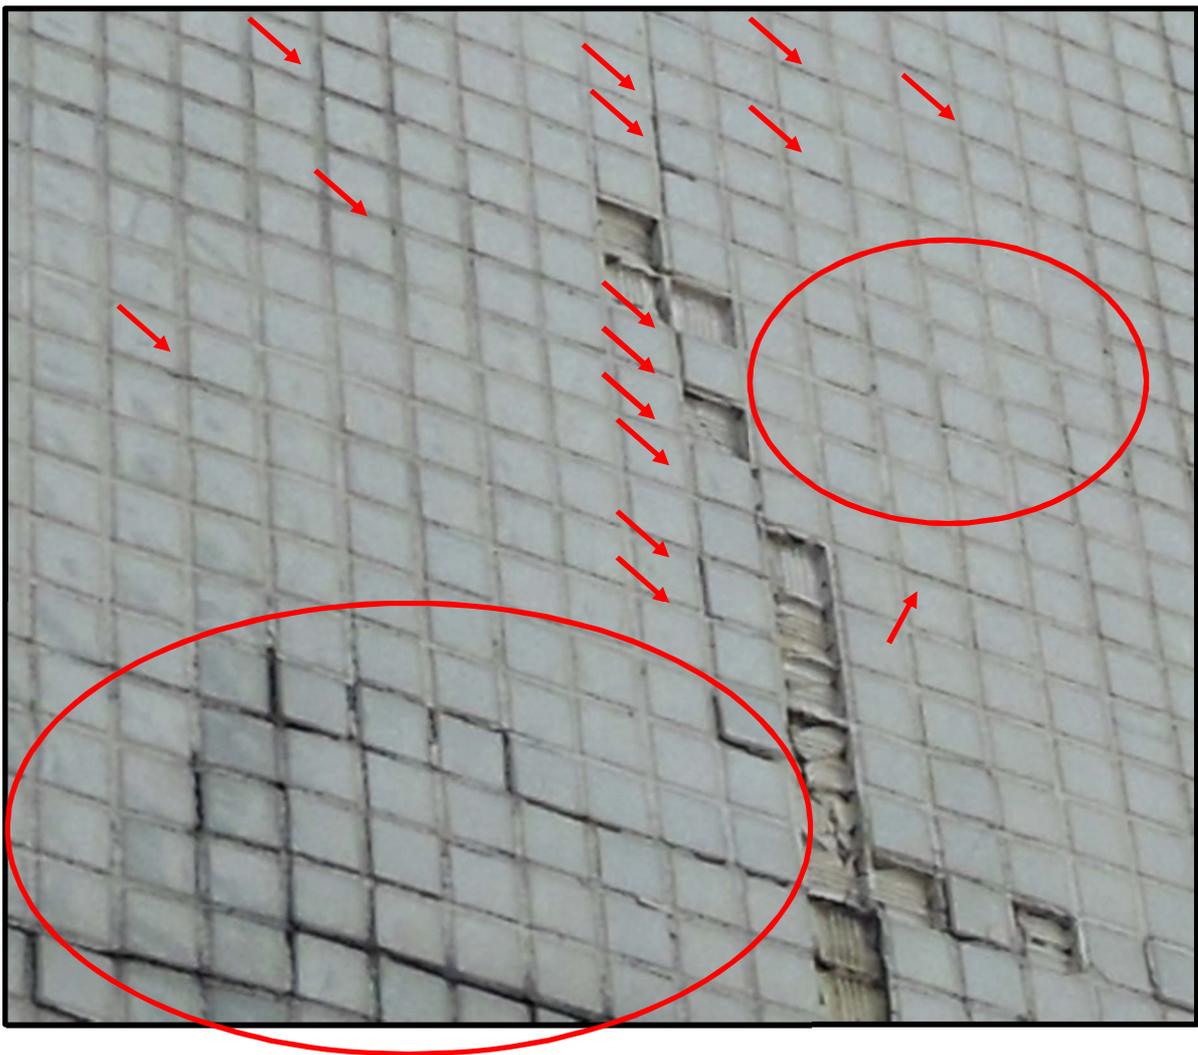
Detalhe de falhas no rejunte (descontinuidades, trincas e fissuras).
